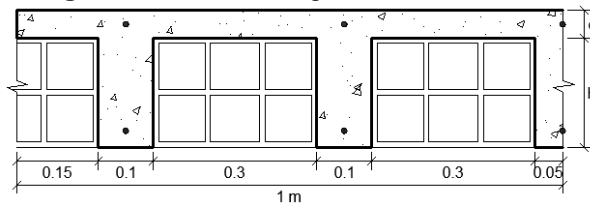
Losa aligerada en 1 dirección.
